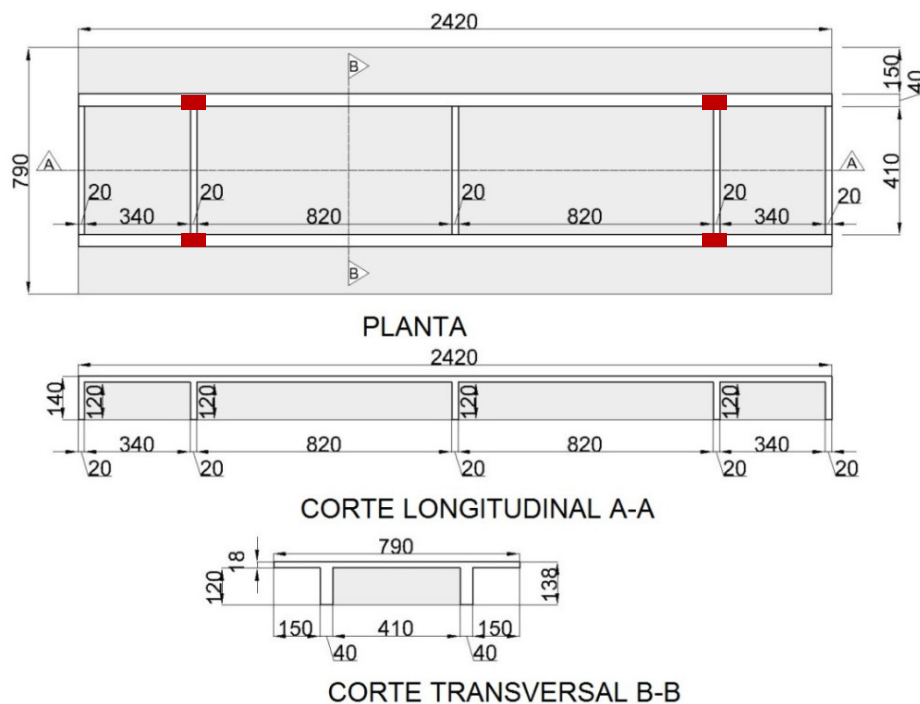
Dimensões em cm da superestrutura da ponte de estudo
